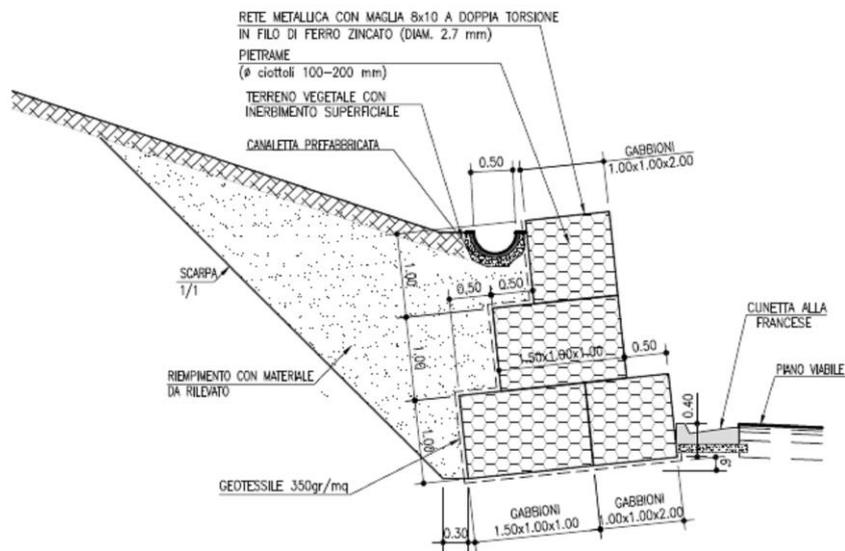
Sezione trasversale muro in gabbioni H = 3m
